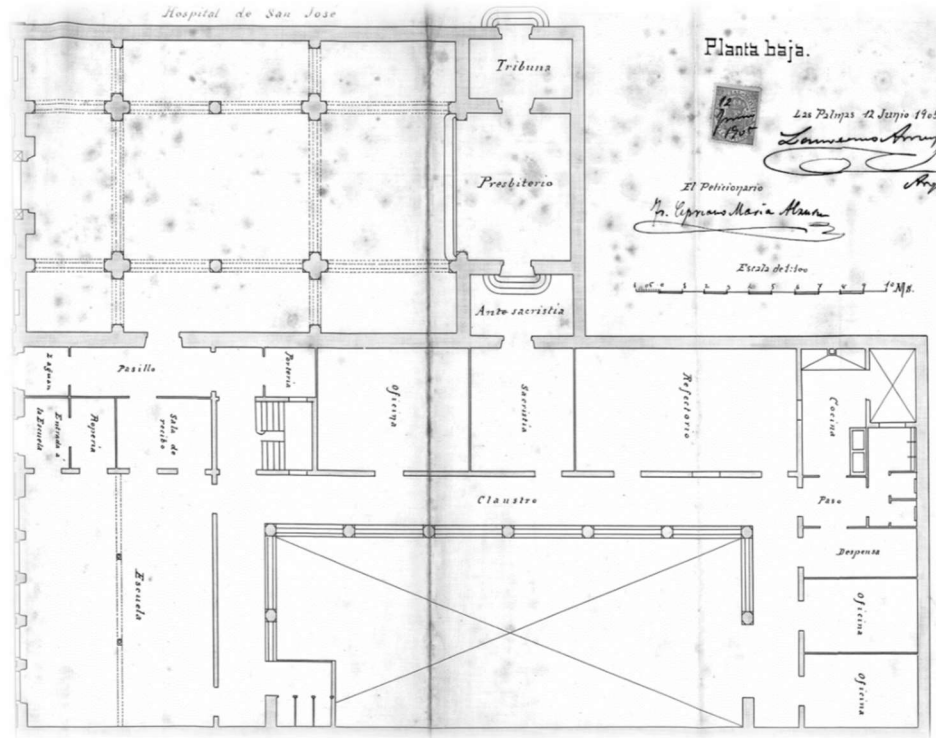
, planta baja de la Iglesia y del Convento. Fuente fichas del PGO. LPGA, ficha ARQ182
